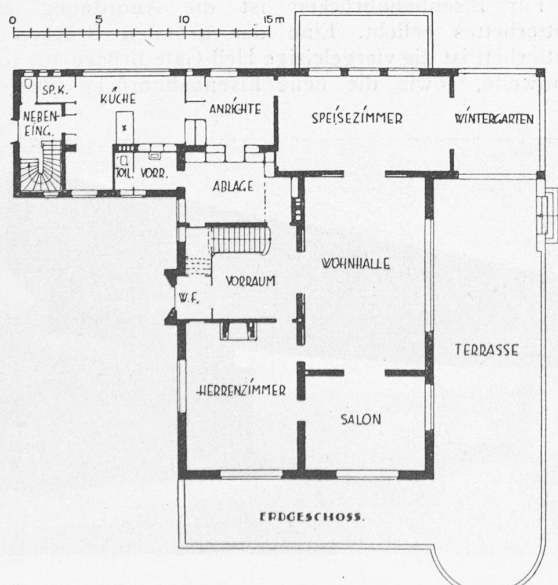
und 7. Grundrisse zum Hause Dr. B. in Dahlem. — 1:400.
